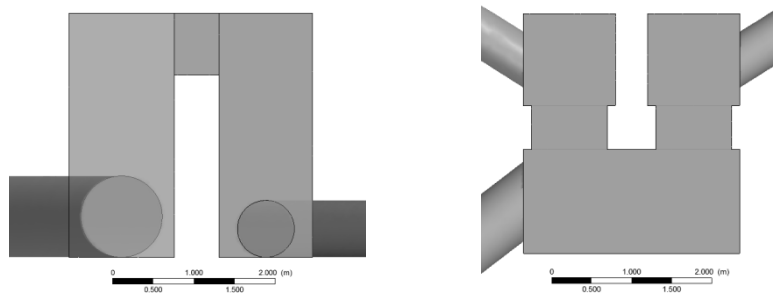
Vista de perfil y planta de la arqueta de reparto de entrada a decantación
